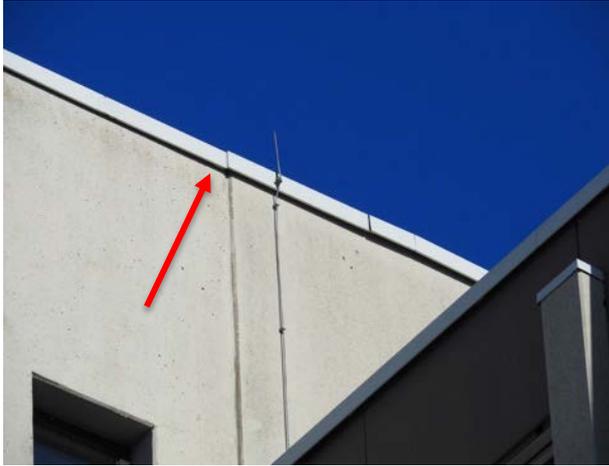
Spalt im Bereich des Flachdachabschlusses am Gebäude in der Mehlbeerstr. 6
